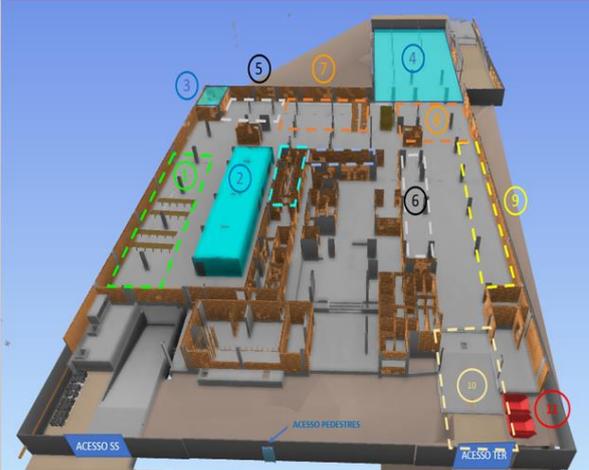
Layout do canteiro durante a execução da estrutura e alvenaria da torre.
